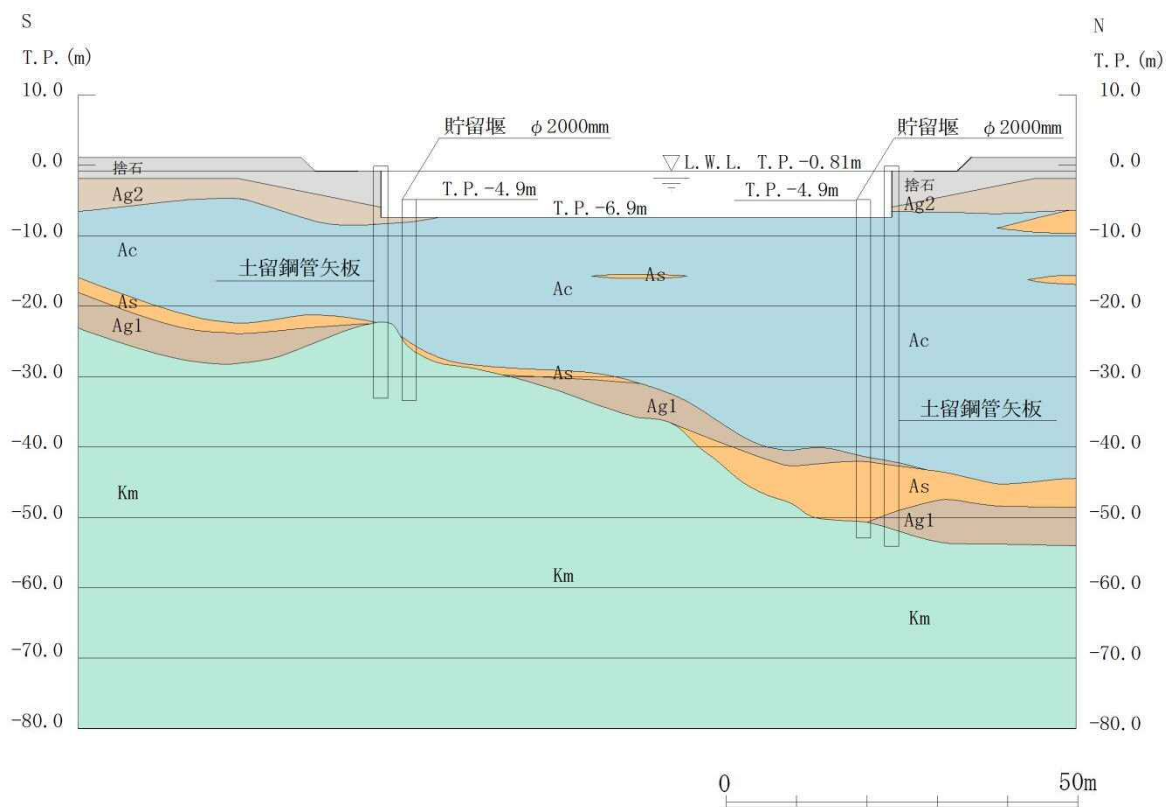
(3) 貯留堰の断面図 (NS-1)
